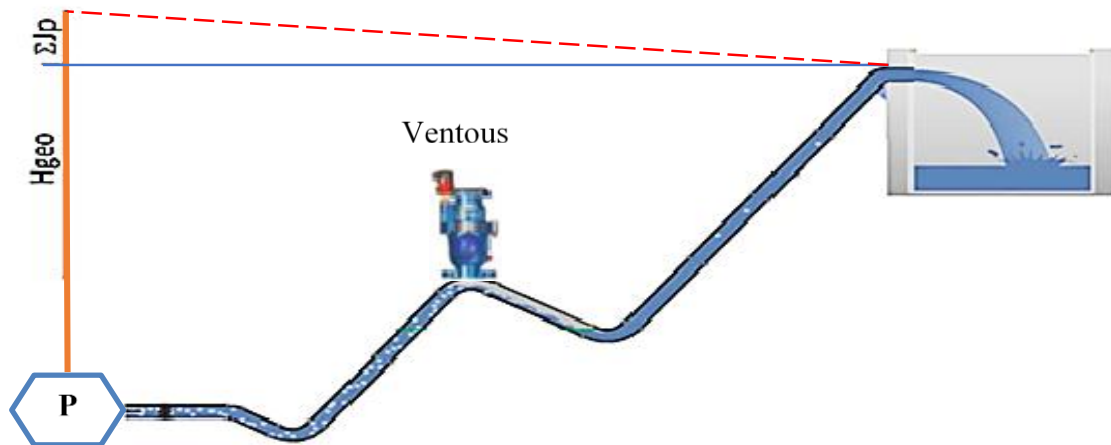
Schéma illustratif d'installation d'une ventouse.
